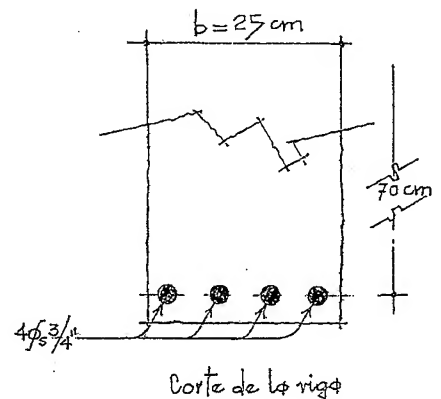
Corte transversal de la viga y colocación de varillas en un lecho.
